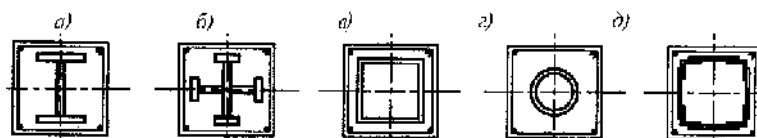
Типы поперечных сечений сталежелезобетонных колонн
